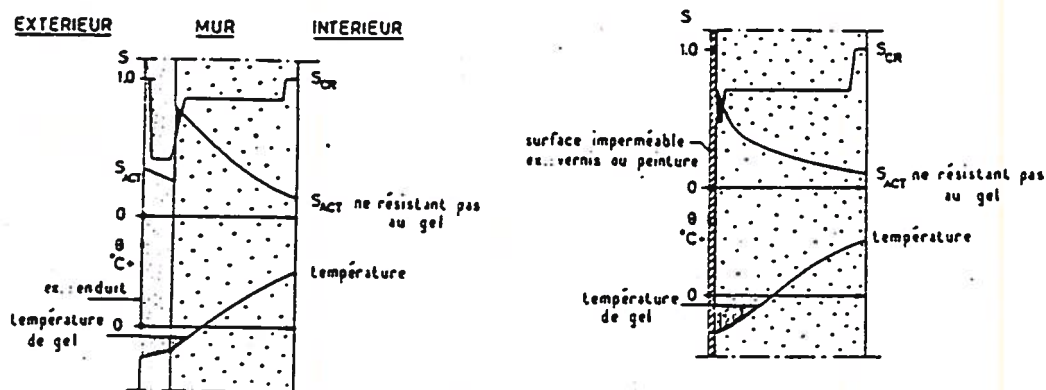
SECTION D'UN MUR CONSTRUIT AVEC DEUX MATERIAUX DIFFERENTS ET UNE SURFACE EXTERIEURE RECOUVERTE D'UNE COUCHE PROTECTRICE (22)
